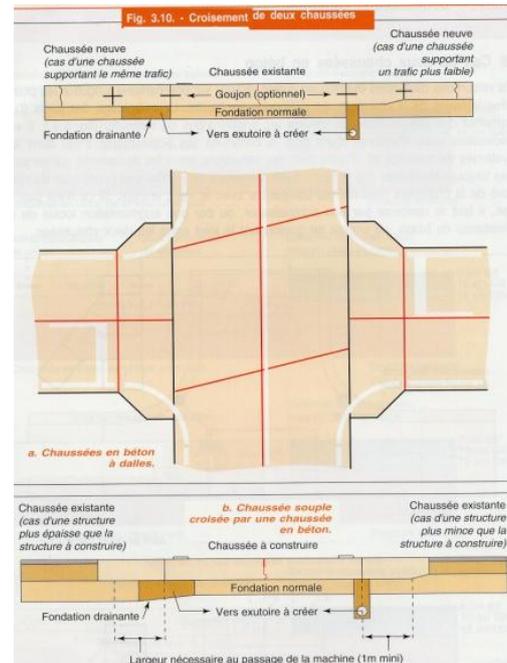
Exemple d'un calepinage des joints d'un carrefour à niveau entre deux chaussées en béton de ciment ; extrait de (5).
